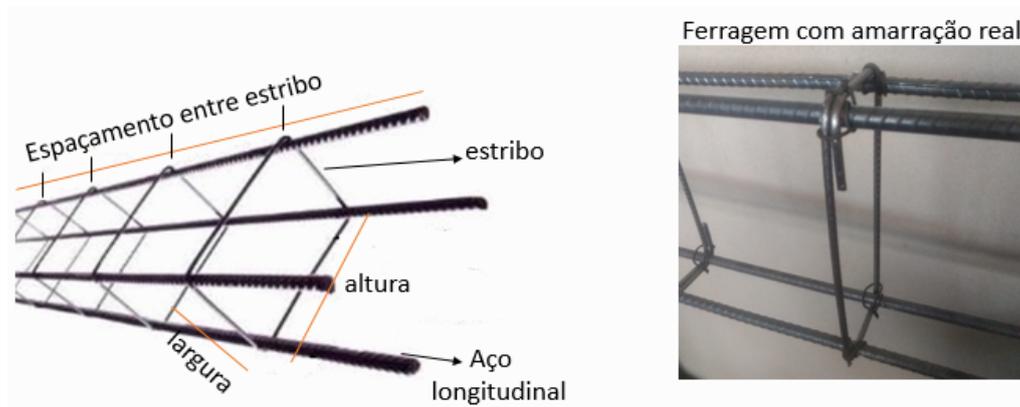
Ferragem interna que será colocada em todas as estruturas de concreto como minipilar, cinta da base, pilar e cinta superior (viga).
